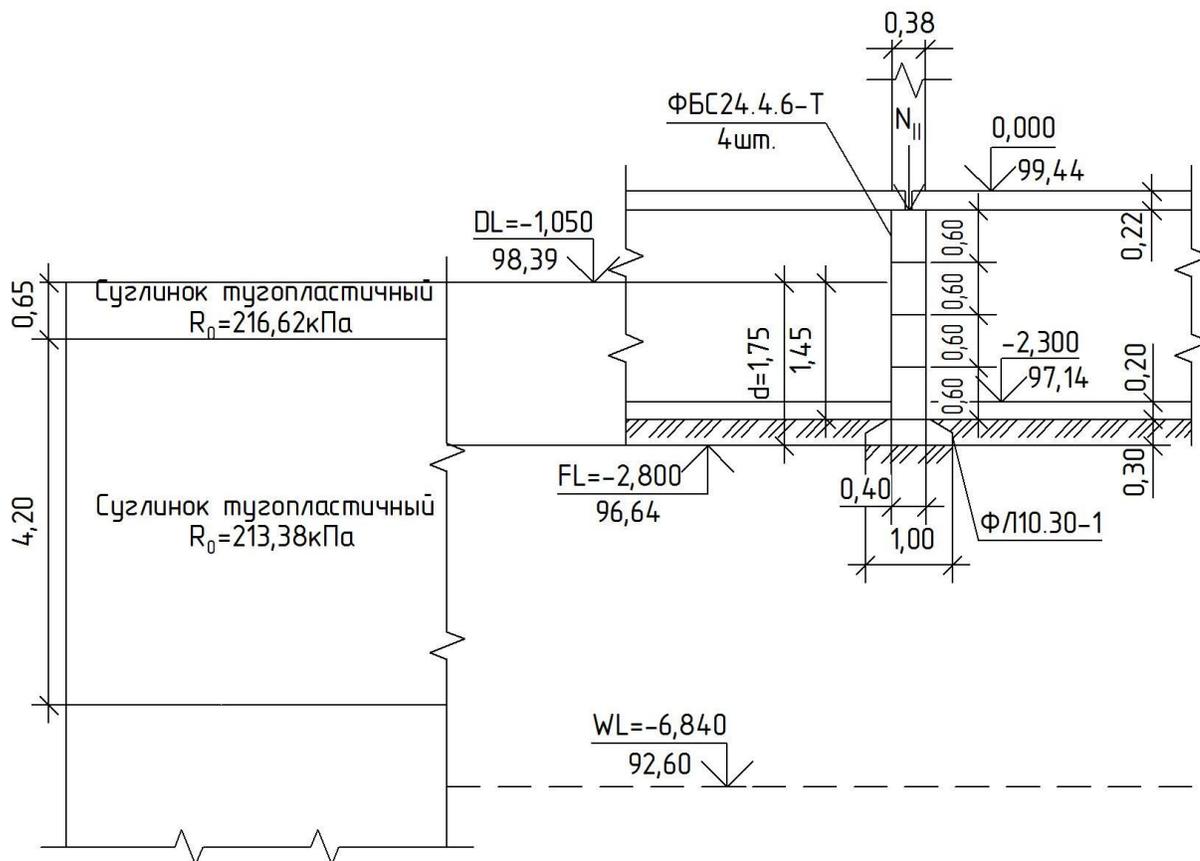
Схематический разрез фундамента под внутреннюю стену
